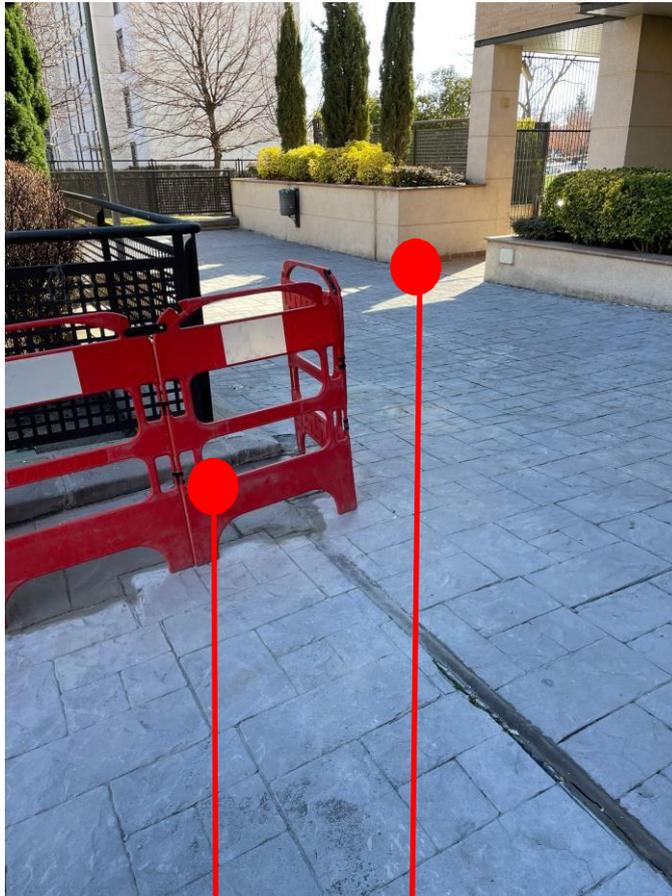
zona donde se ha localizado la rotura [Fecha 1]
